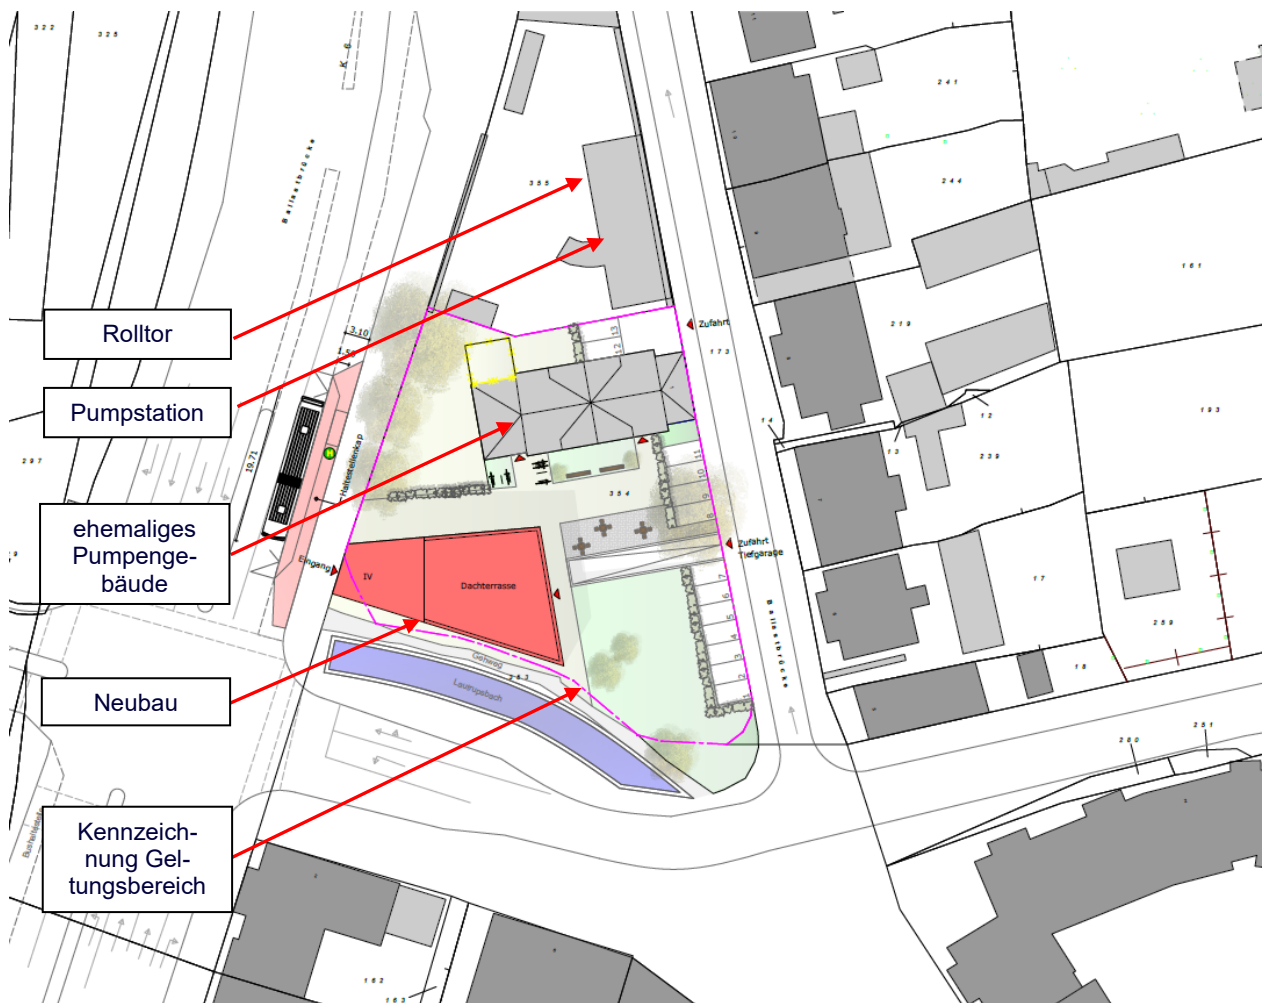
Lageplan mit Kennzeichnung des Geltungsbereichs
